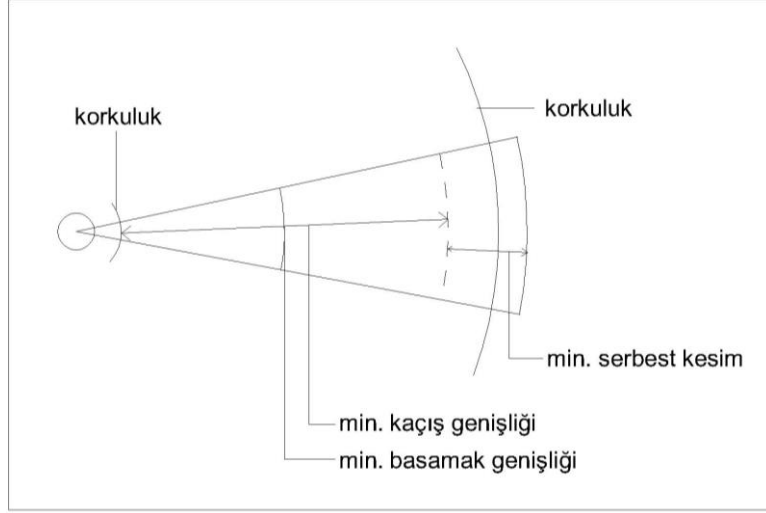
10 Merdiven dış kenarından bırakılan minimum serbest genişlik (mm)
